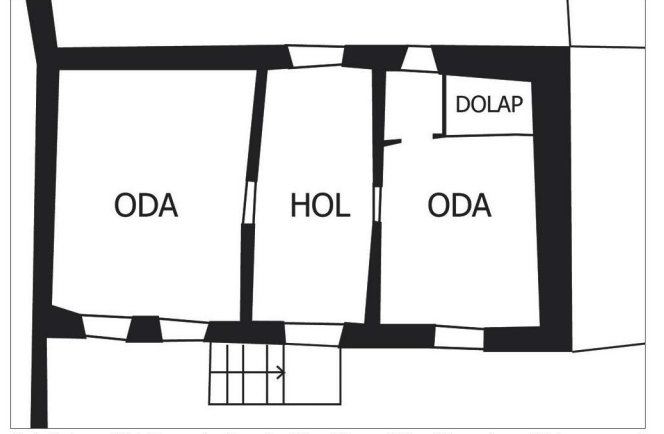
890 Parsel (Tescilli) 1. Kat Planı / Building lot: 890 (registered), first floor plan.
